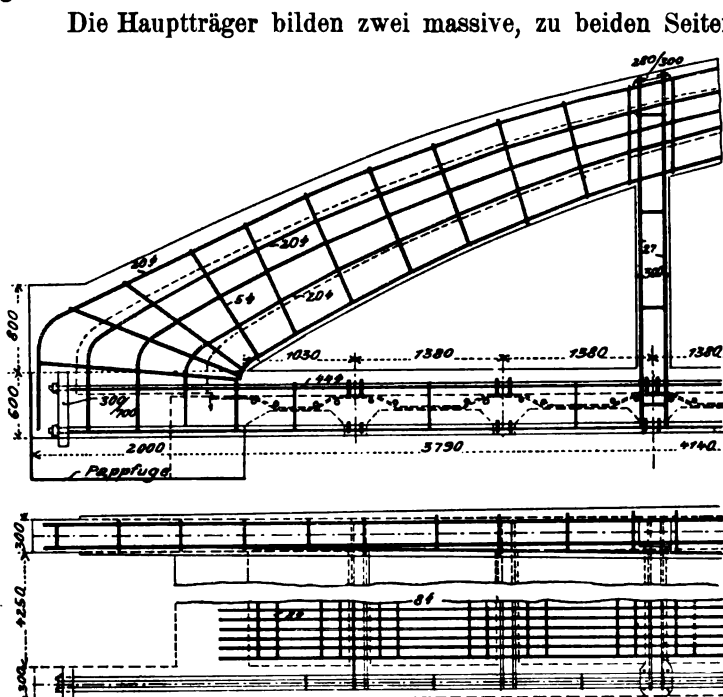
Armierungseinzelheiten der Brücke bei Bernhausen.
